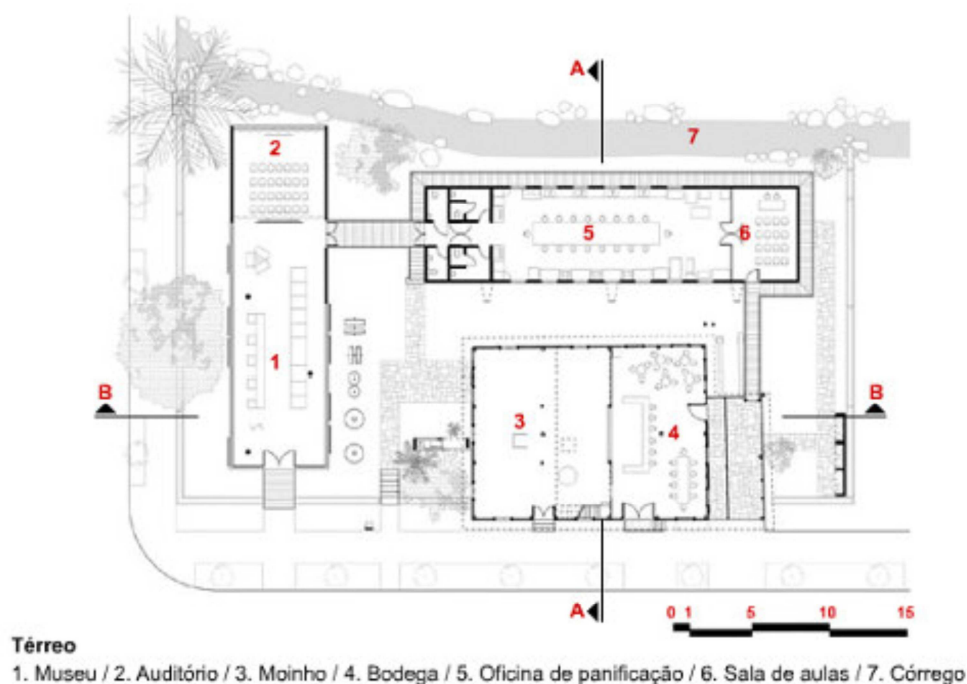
Planta baixa do conjunto arquitetônico Museu do Pão.
